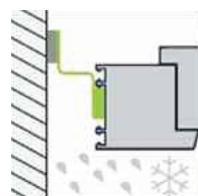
Fixation de la membrane sur la tranche du profilé.
